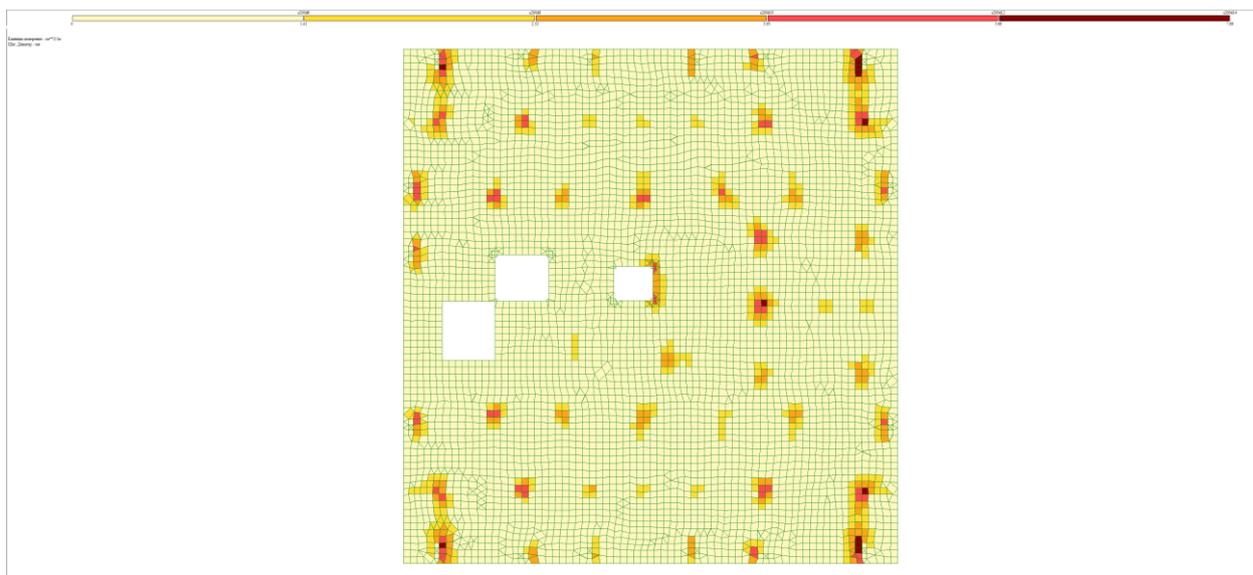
Верхнее армирование перекрытия этажа по оси X+
